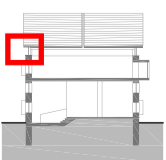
Detail II, Trapezdach Anschluss Fenster, 1:5
